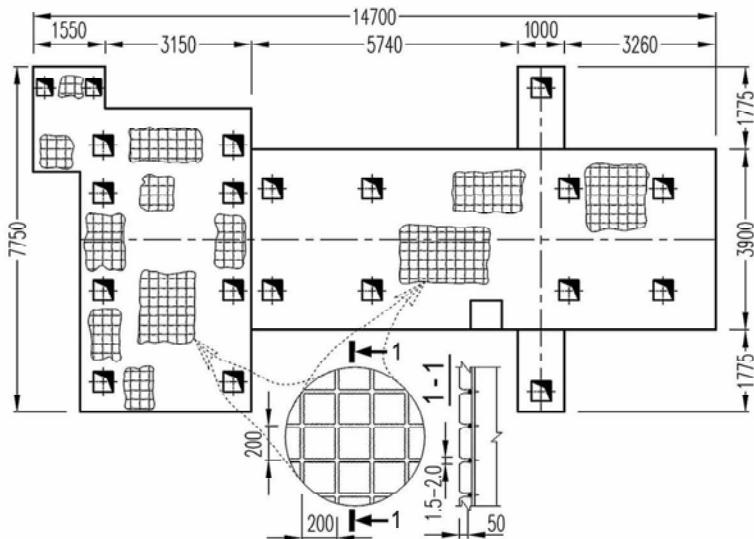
План фундаменту та характер трічиноутворення на верхньому обрізі фундаментної плити
